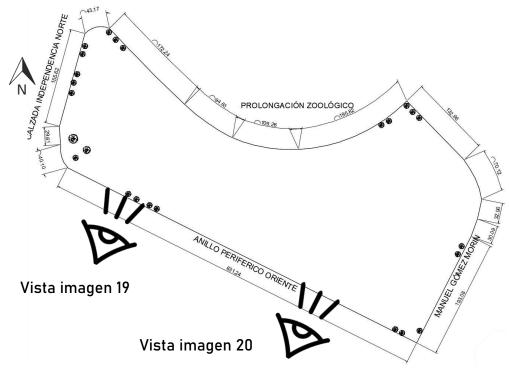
Vista en planta del predio, referencias a imagen 19 y 20.
